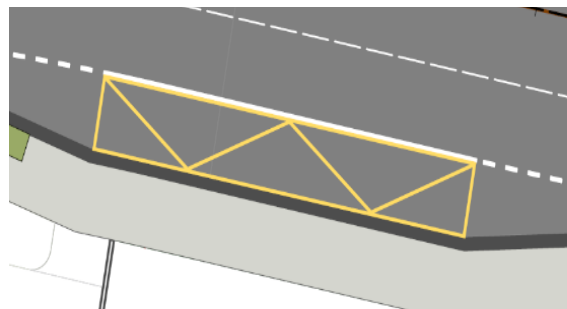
Vista en planta de la vía principal con estacionamientos paralelos. Fuente: URBE, octubre 2025.
